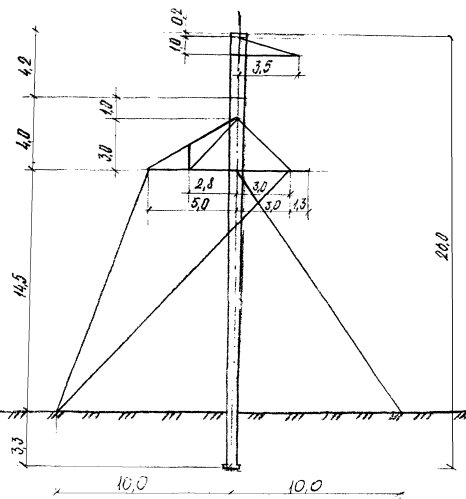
Одноопорные железобетонные опоры ВЛ 220 кВ
